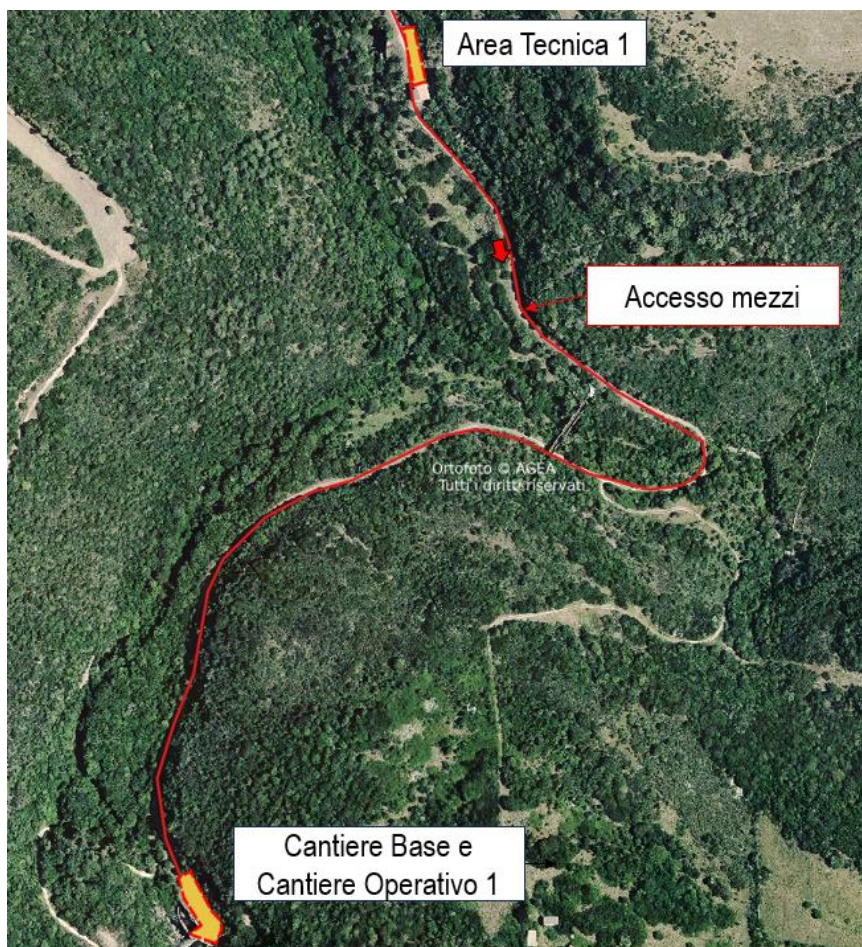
Schema di cantierizzazione in corrispondenza dell'area di intervento
